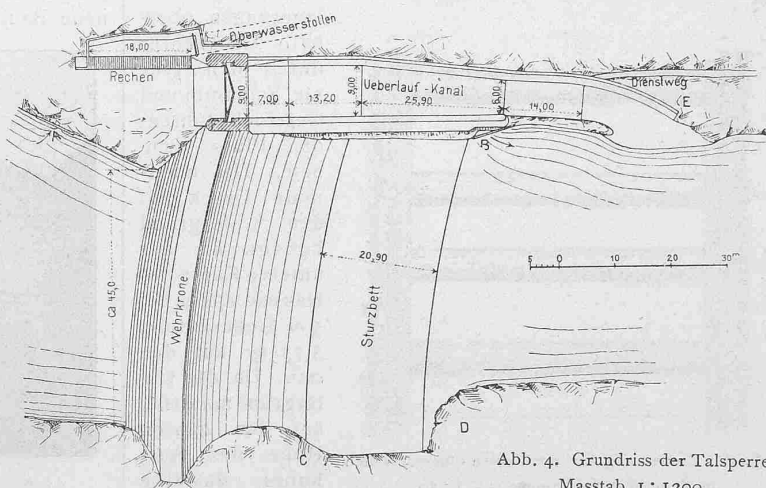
Grundriss der Talsperre. Masstab 1:1200.
